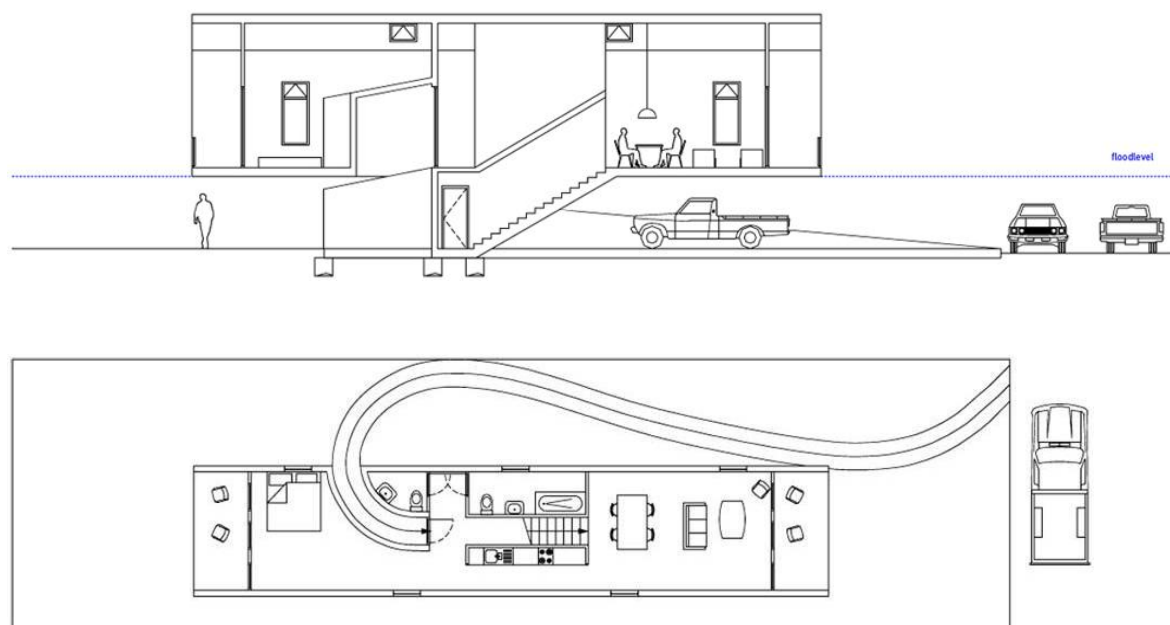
Perspectiva, corte e planta da casa na rampa.
